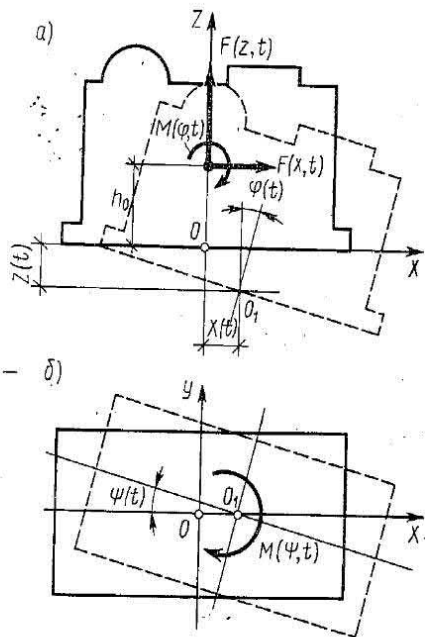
Схема внешних воздействий и перемещений при расчетах колебаний фундамента
